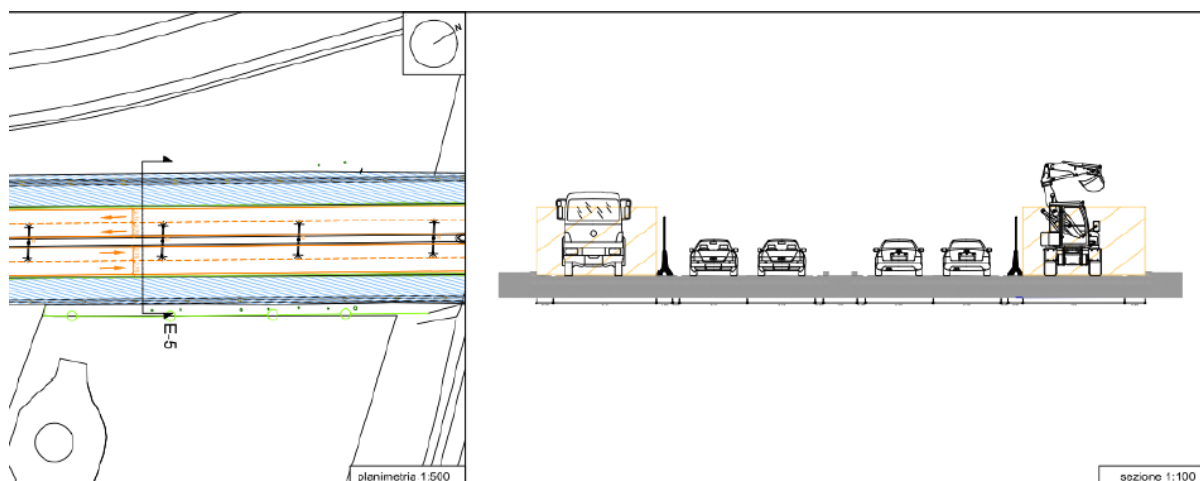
Tipologico cantiere con sede centrale Fasi 1 e 2
